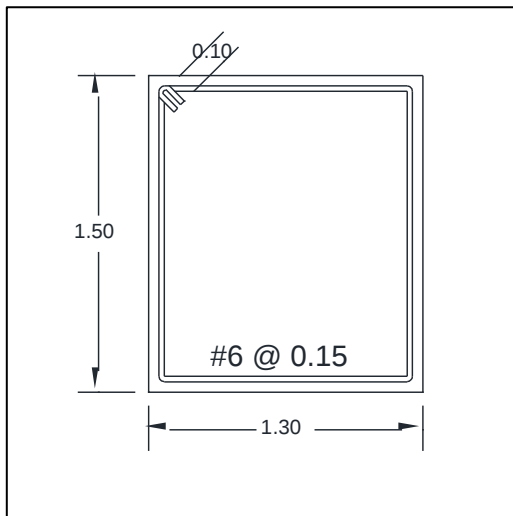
Detalle de armado transversal del cabezal para el puente 30P05-1. Acotaciones en metros.
